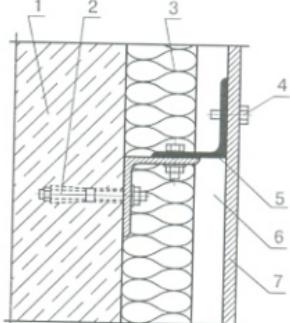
Схема анкерного крепления навесного фасада на несущей конструкции:
